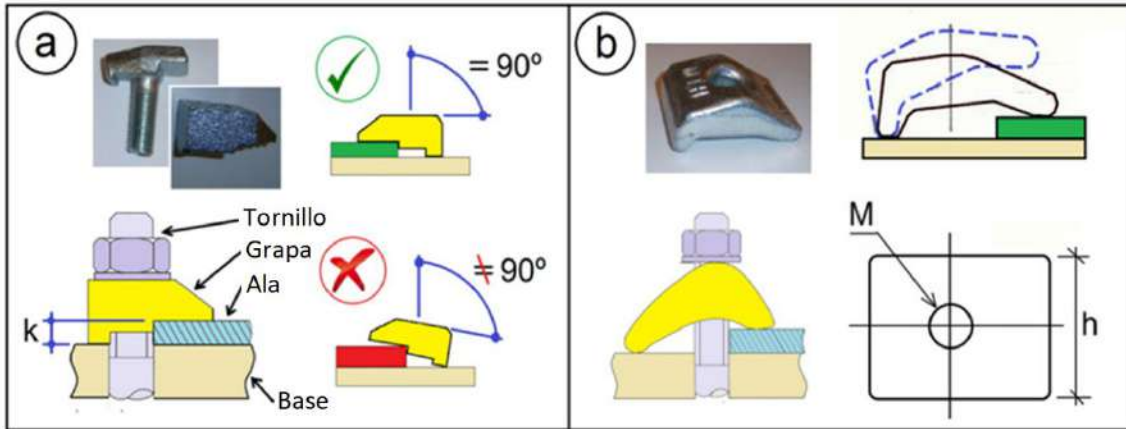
a) Croquis de las grapas planas. b) Croquis de la grapa pivotante. (fuente: Fig.2 de Cabaleiro et al. 2016)
